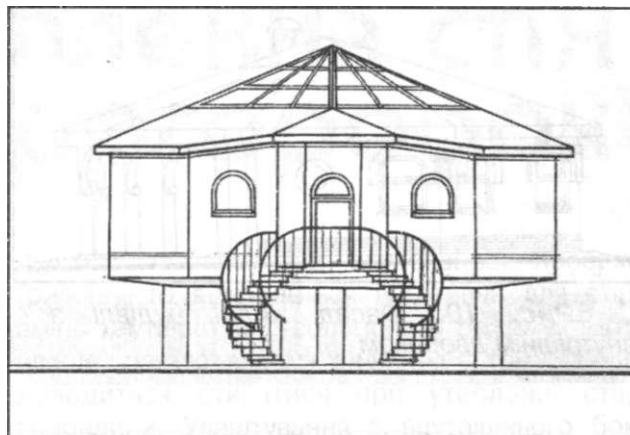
Головний фасад житлої будівлі "на ніжках"
